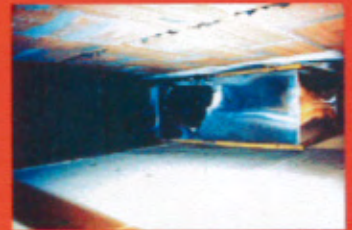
Brandversuch mit einer Kastendoppelfassade (vertikale und horizontale Aluminiumabschottungen) - Abstand zwischen Innen- und Außenfassade: 0,6 m, Brandlast: 1 Brandlastpalette mit 166 kg.
